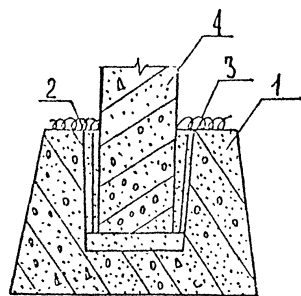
Обогрев бетона стыка кирпич в стакане фундамента
